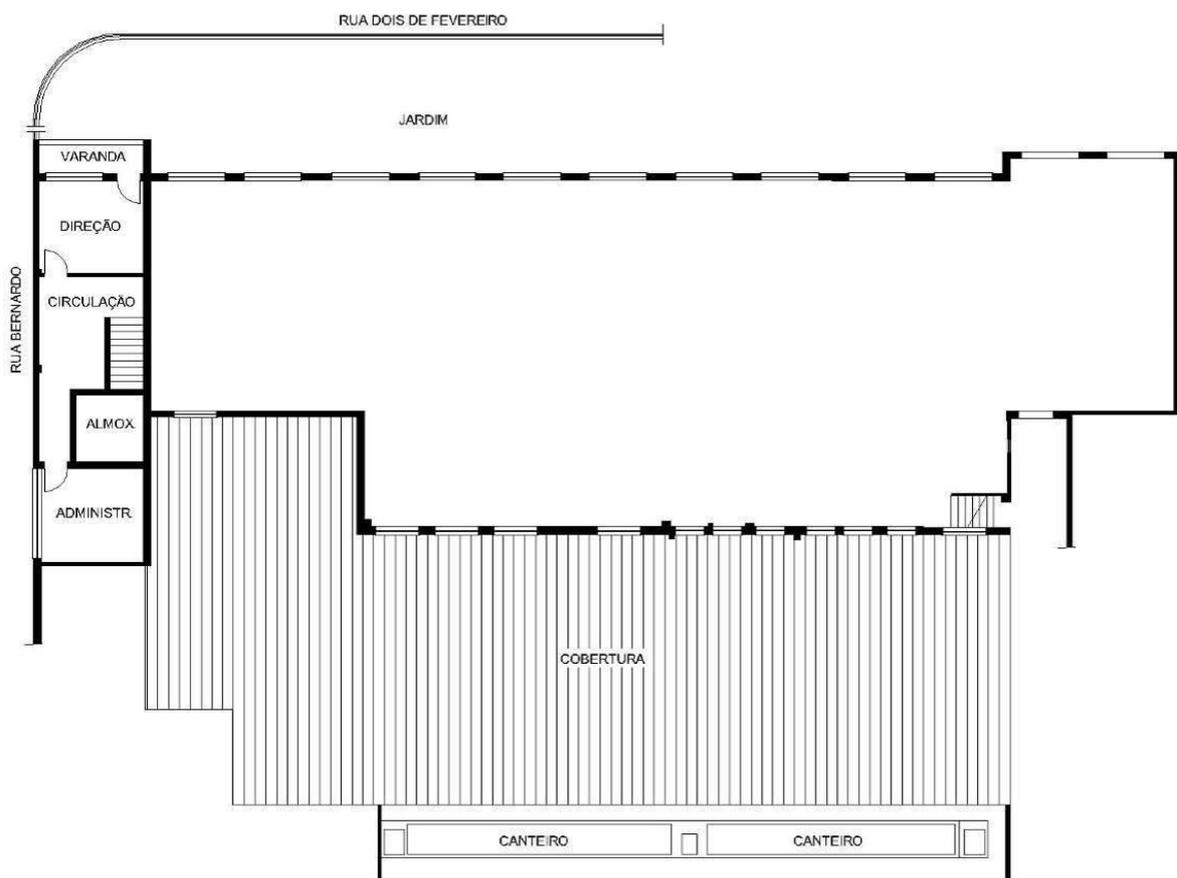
Planta do CAPSad II Raul Seixas – primeiro pavimento.
